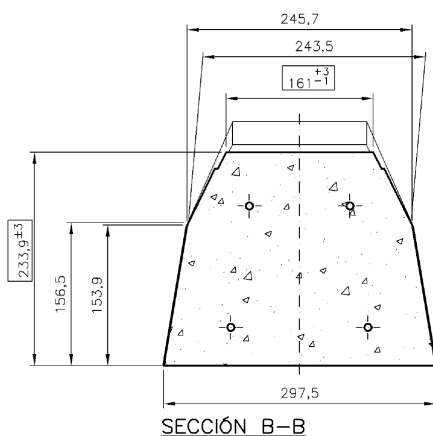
Plano de sección de traviesa PR-10. Fuente: Andaluza de Traviesas, S.A.
